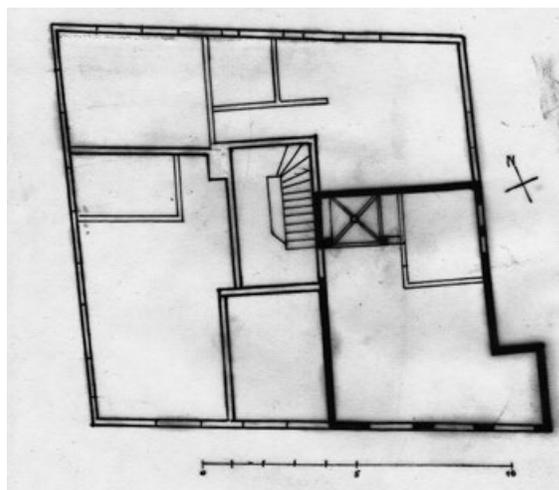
Biberach, Engelgasse 4, Obergeschossgrundriss. (Hervorgehoben das Eckzimmer mit dem kleinen Gewölbe und dem Badezimmereinbau).
